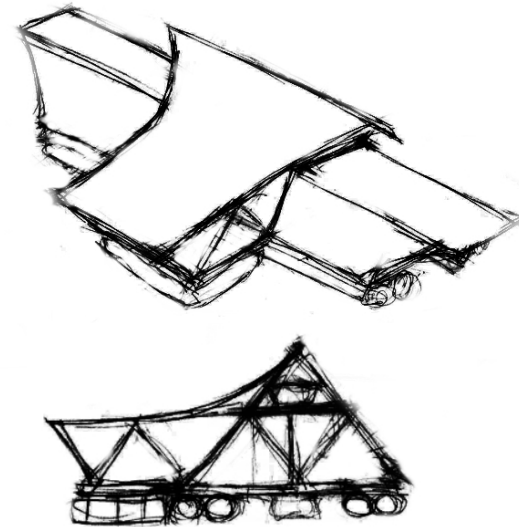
Elevação com cobertura em duas camadas para ventilação.
